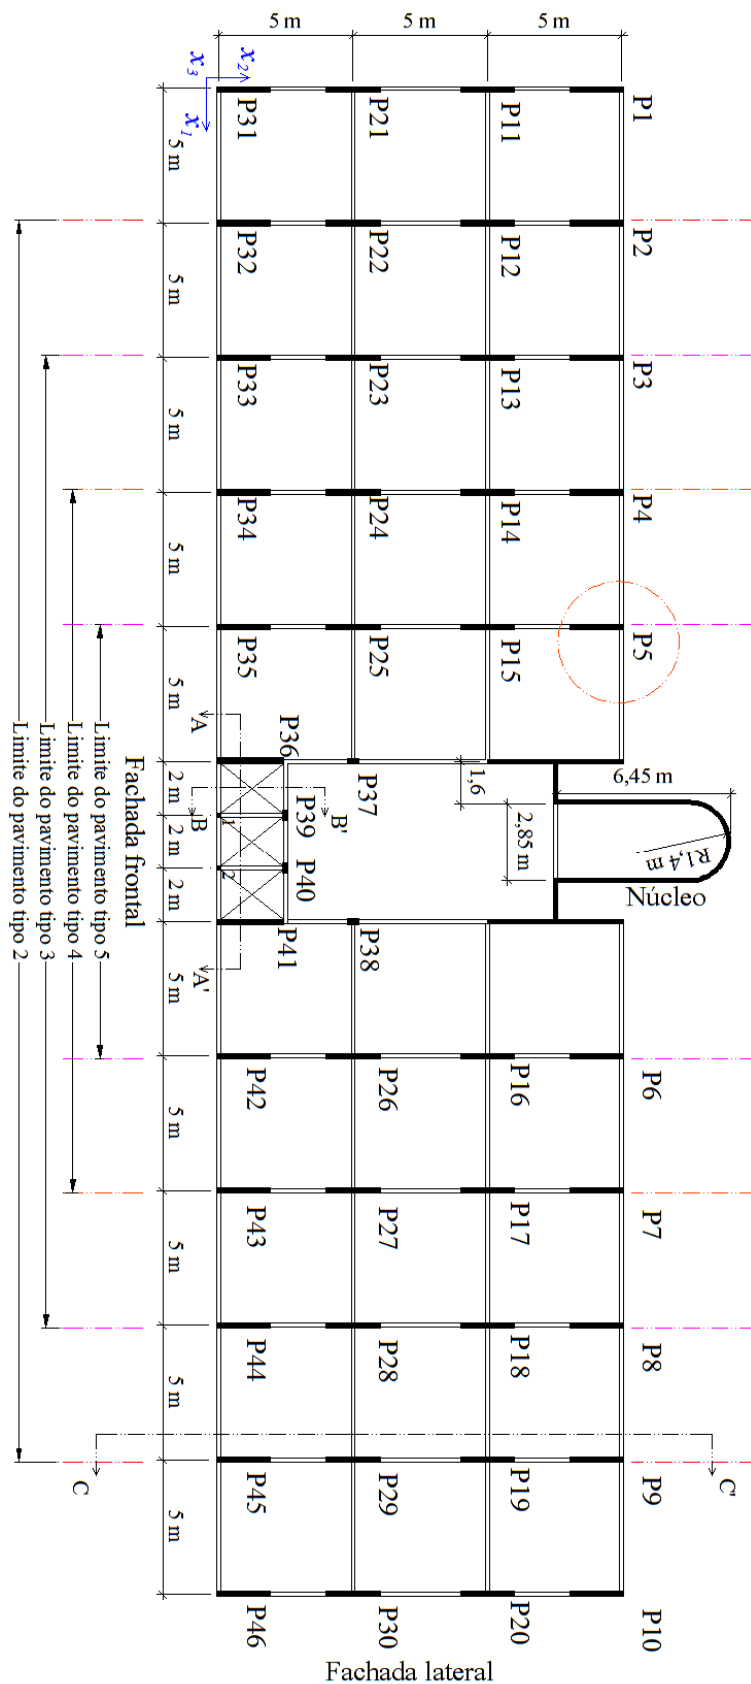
Exemplo 8: Planta dos pavimentos tipo
